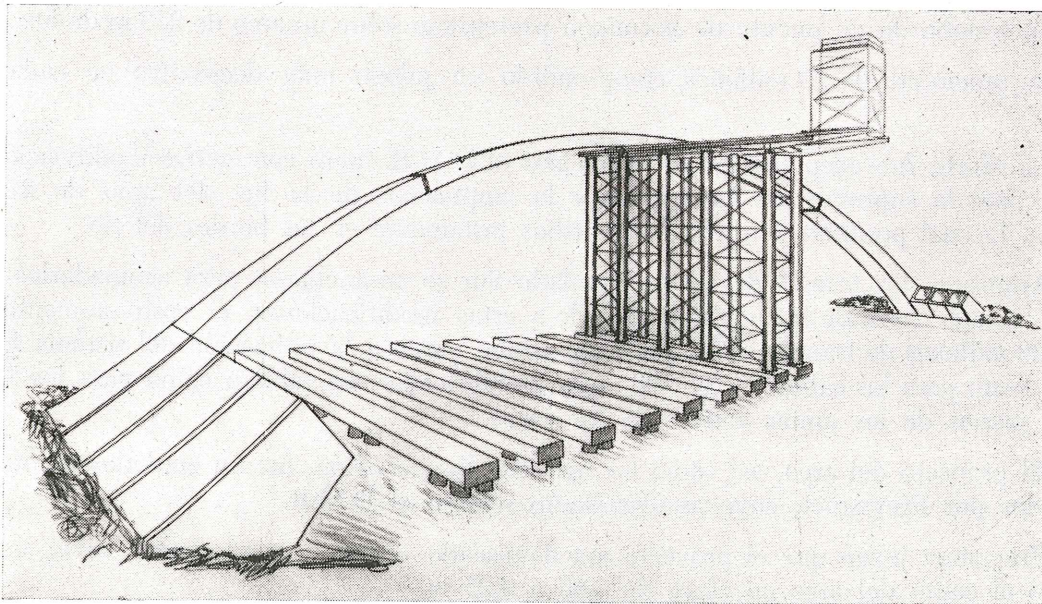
Torre central de la cimbra que asegura la estabilidad lateral y sirve para la elevación de las dovelas.
